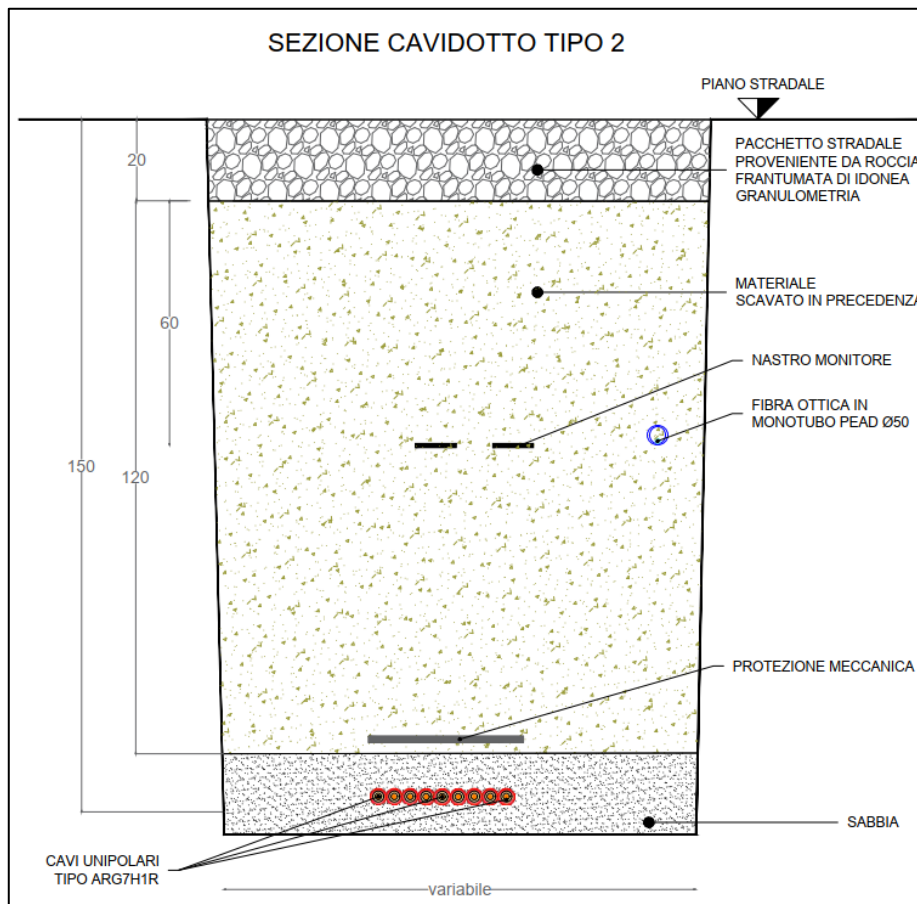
Sezione di posa cavidotto MT a 30 kV – tipo 2
